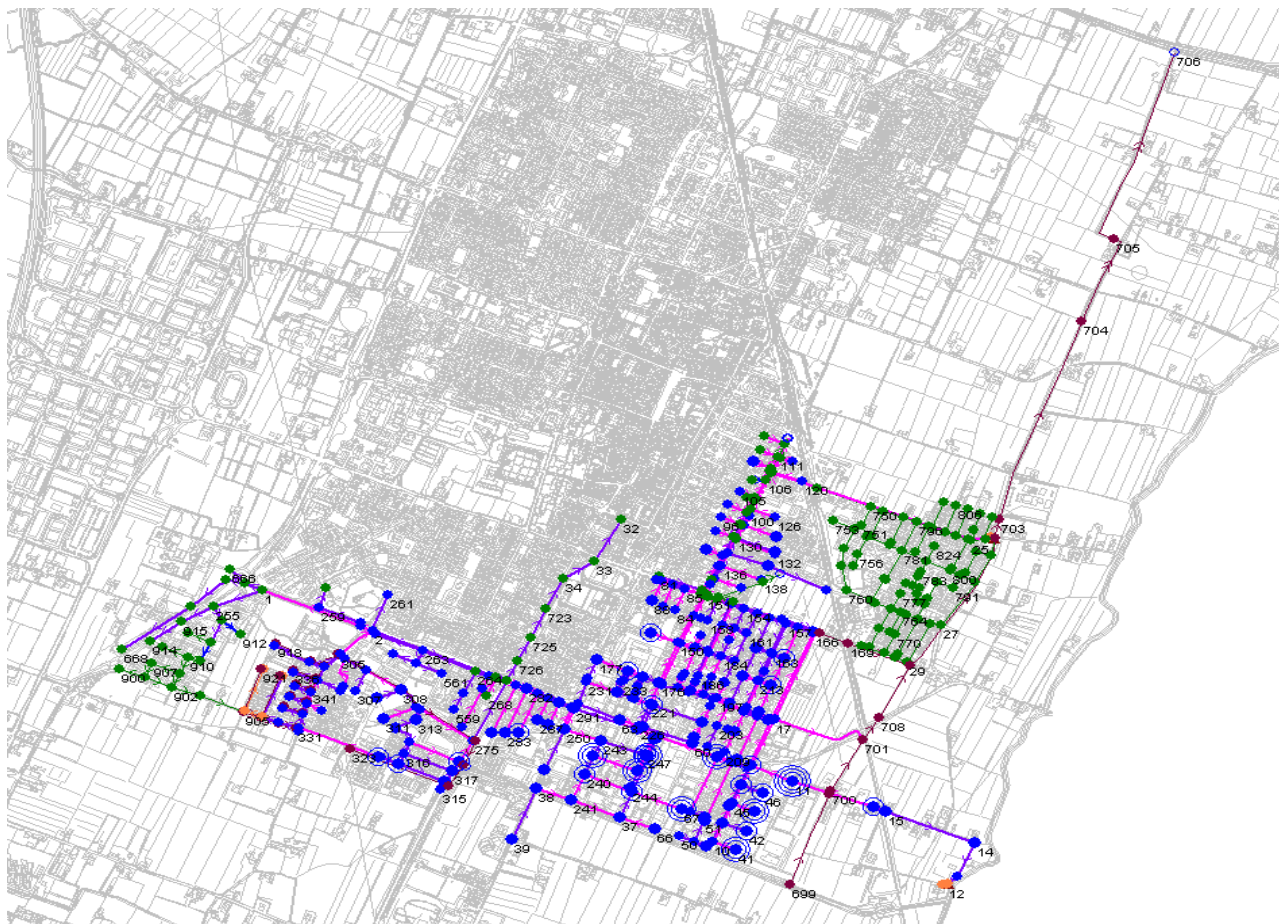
Planimetria delle criticità idrauliche (Stato di fatto)
